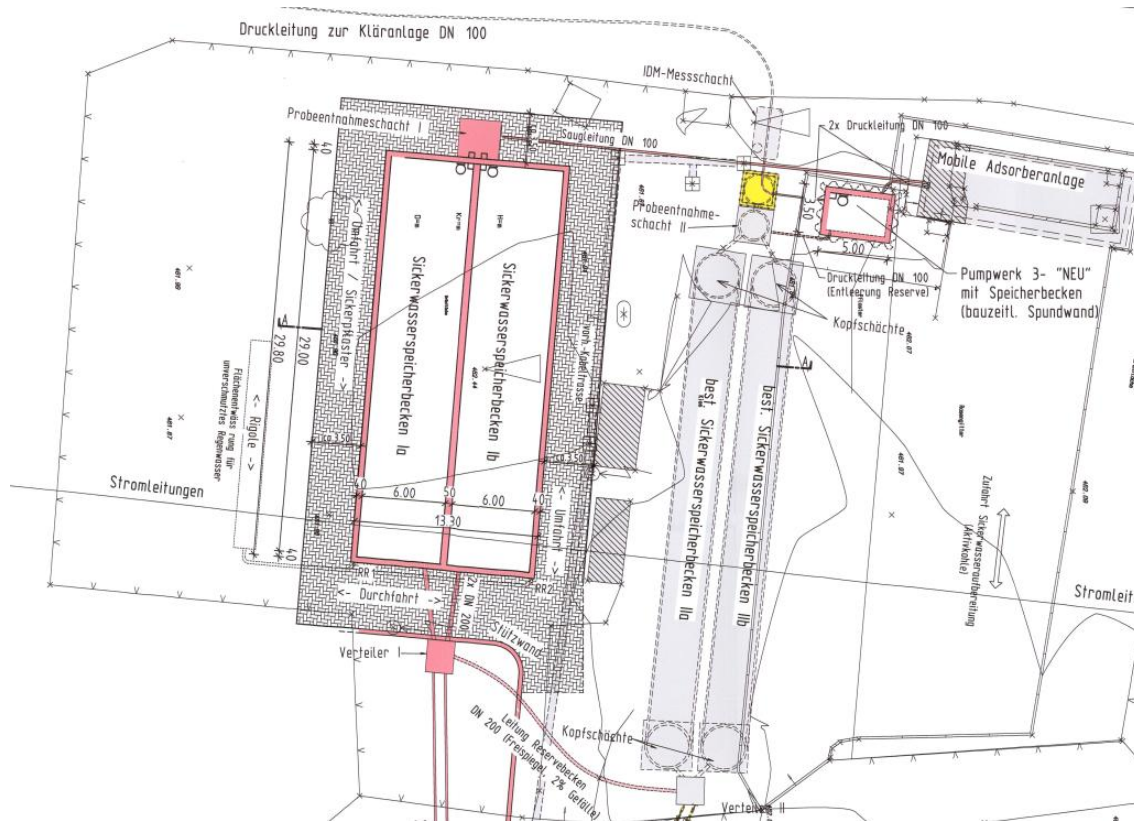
Lageplan Sickerwasserbecken Bestand (Quelle: Lageplan Bestand Sickerleitung)
